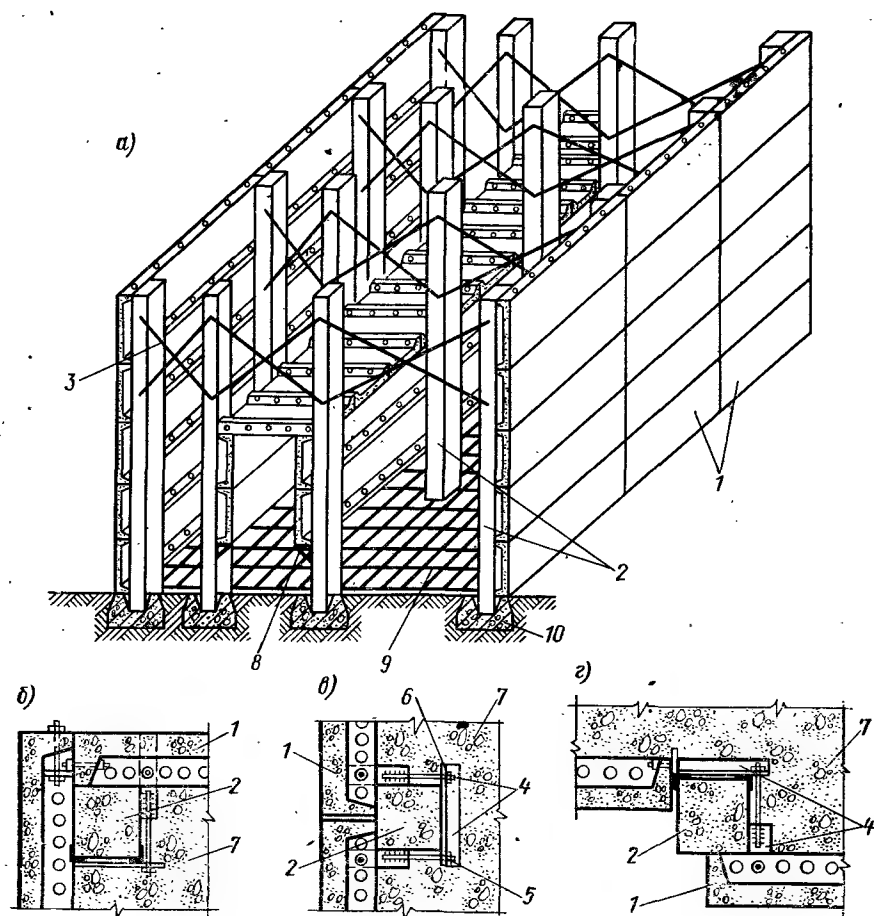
Опалубка-облицовка массивного фундамента под прокатное оборудование:
